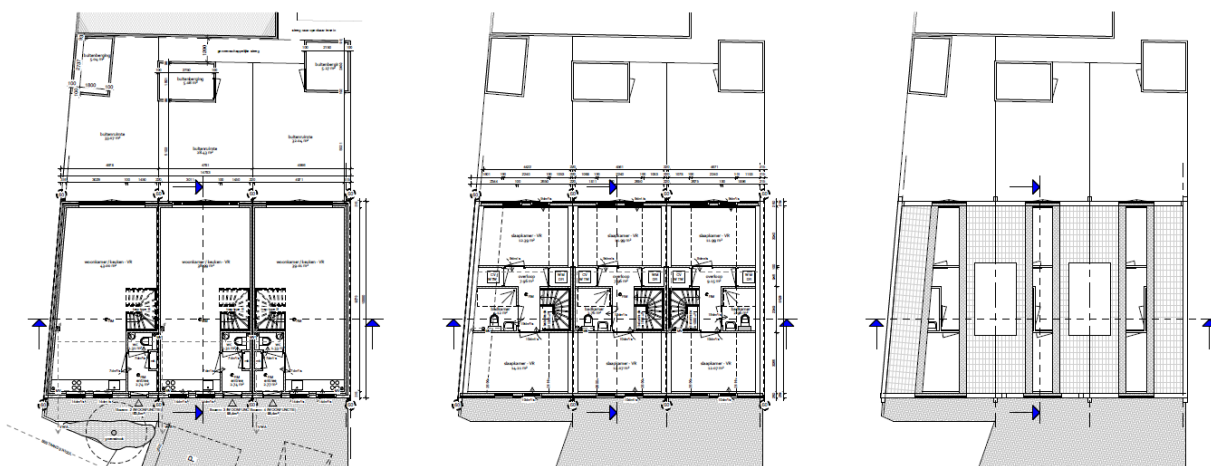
uitsnede situering bouwplan met buitenruimte op plangebied bon: Make Over Groep
